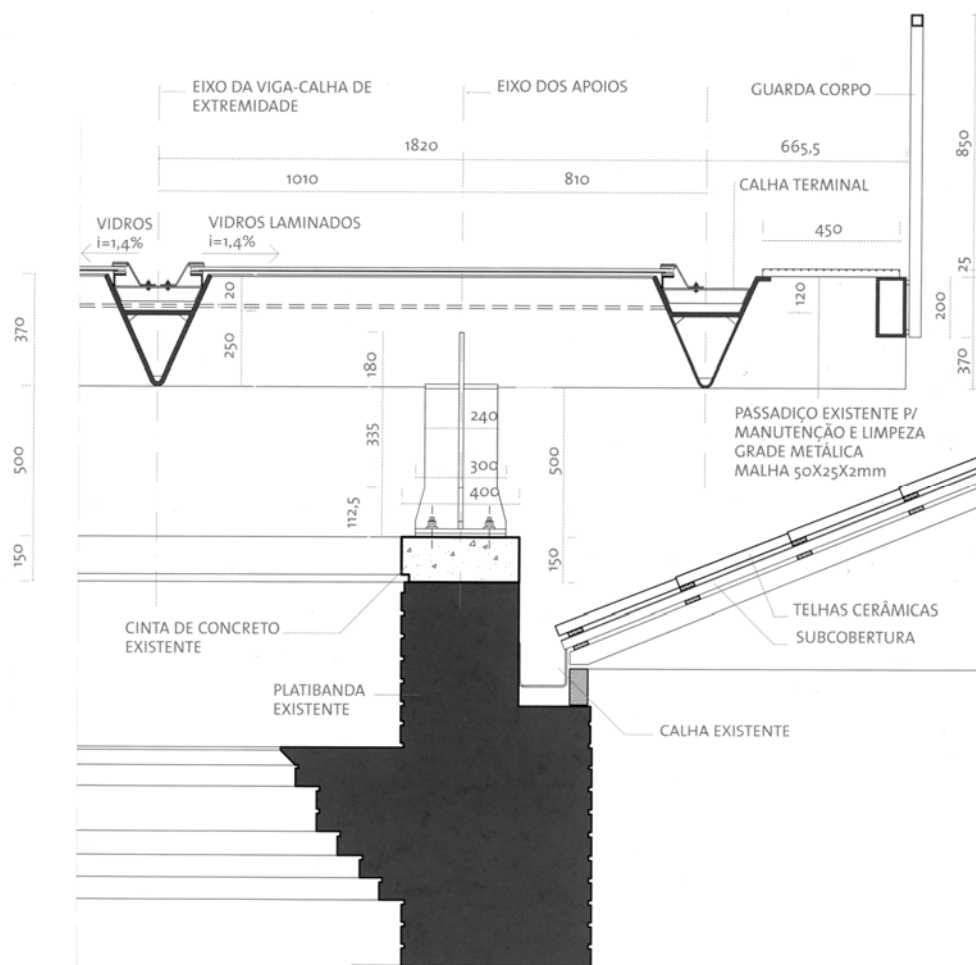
Detalhe da viga principal da clarabóia dos pátios laterais.
